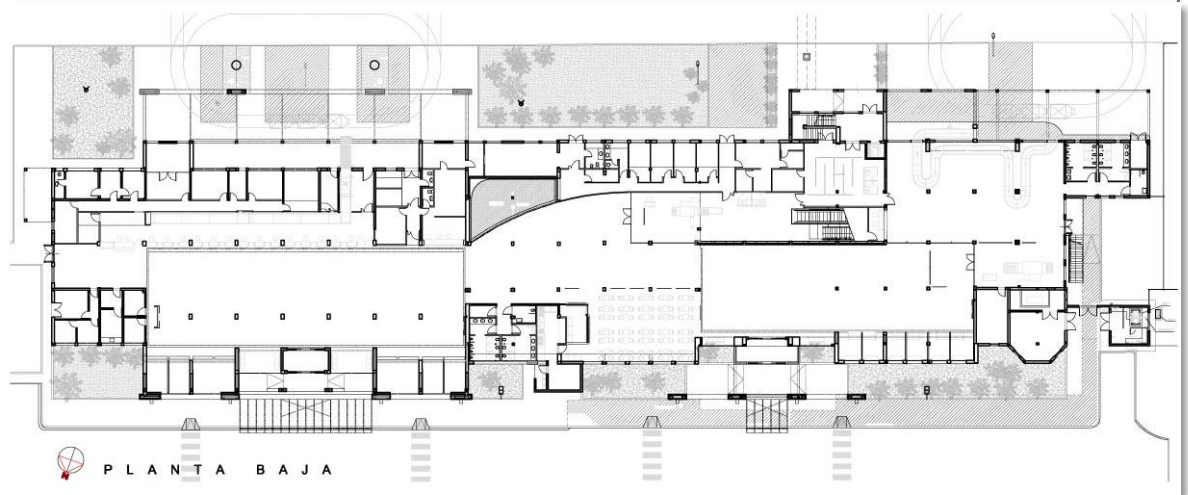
Aeropuerto Almirante Marcos A. Zar, Trelew - Plano de planta baja. Fuente: <https://www.arquimaster.com.ar/galeria/obra211.htm>
